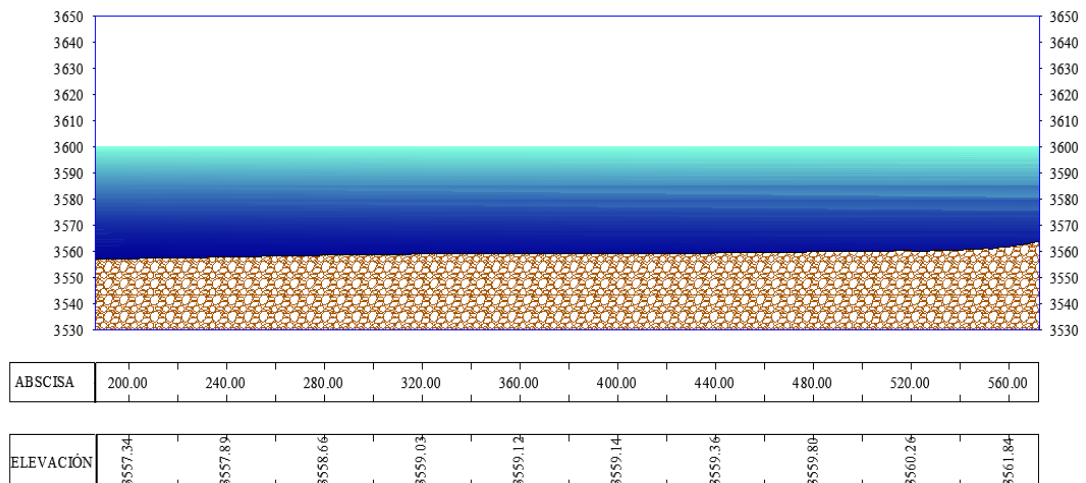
Perfil Transversal (Abscisa 200 a 560) - Área de corte para el punto 3 (Río Pita)
